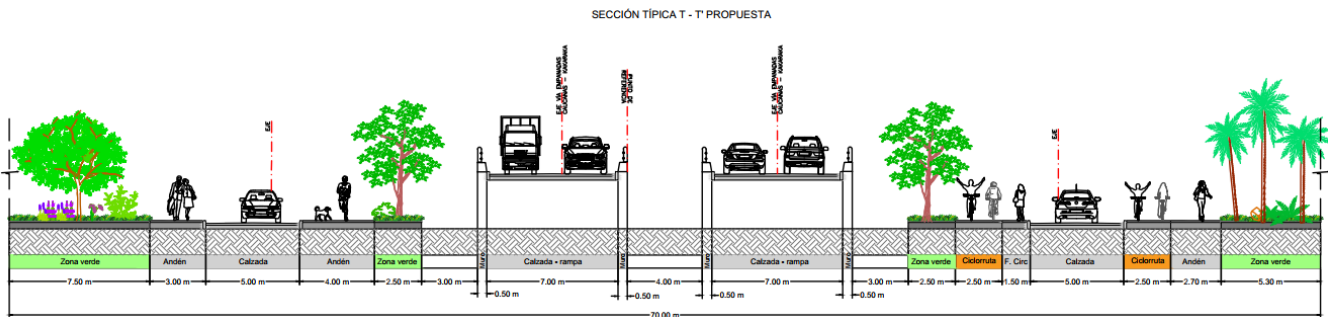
Sección vial propuesta para la intersección y sección vial de la transversal 2.
